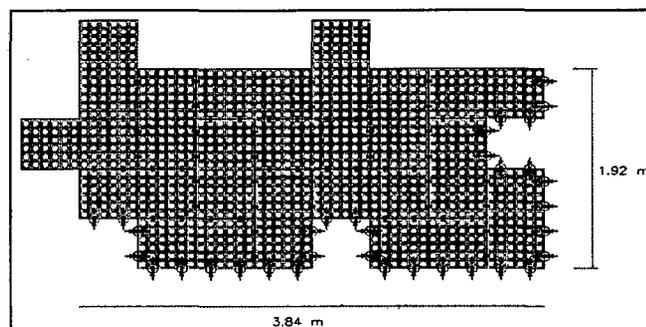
Detalle de proceso de pavimentación con geoterra
